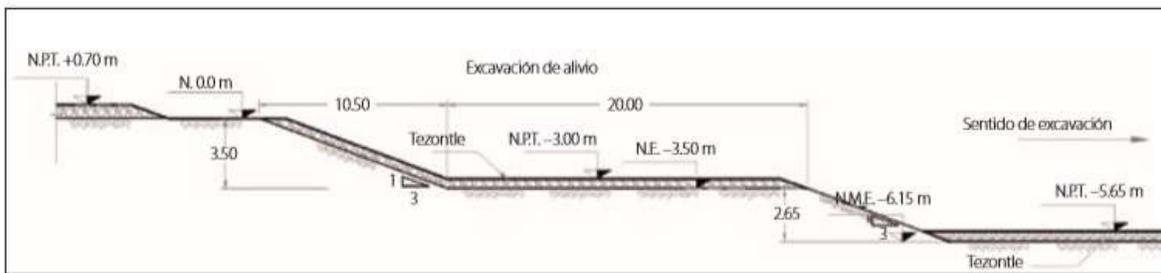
, Cortes Perimetrales para Excavaciones para la losa de Cimentación del NAICM. Fuente: SMIG
